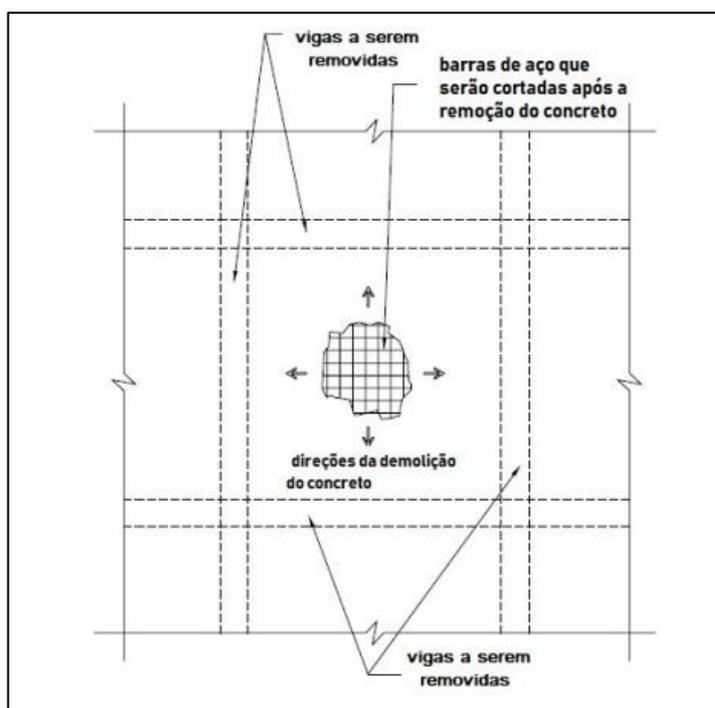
Plano de demolição de lajes armadas em duas direções. (fonte: BUILDINGS DEPARTMENT, 2004 (adaptado))
